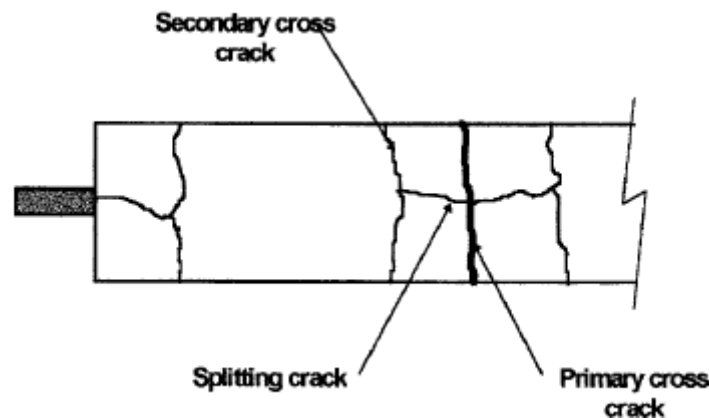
Formación de Fisuras (Cracking Behavior of Reinforced High-Strength Concrete Tension Ties, Llorain, Maurel y Seffo, 1998)
